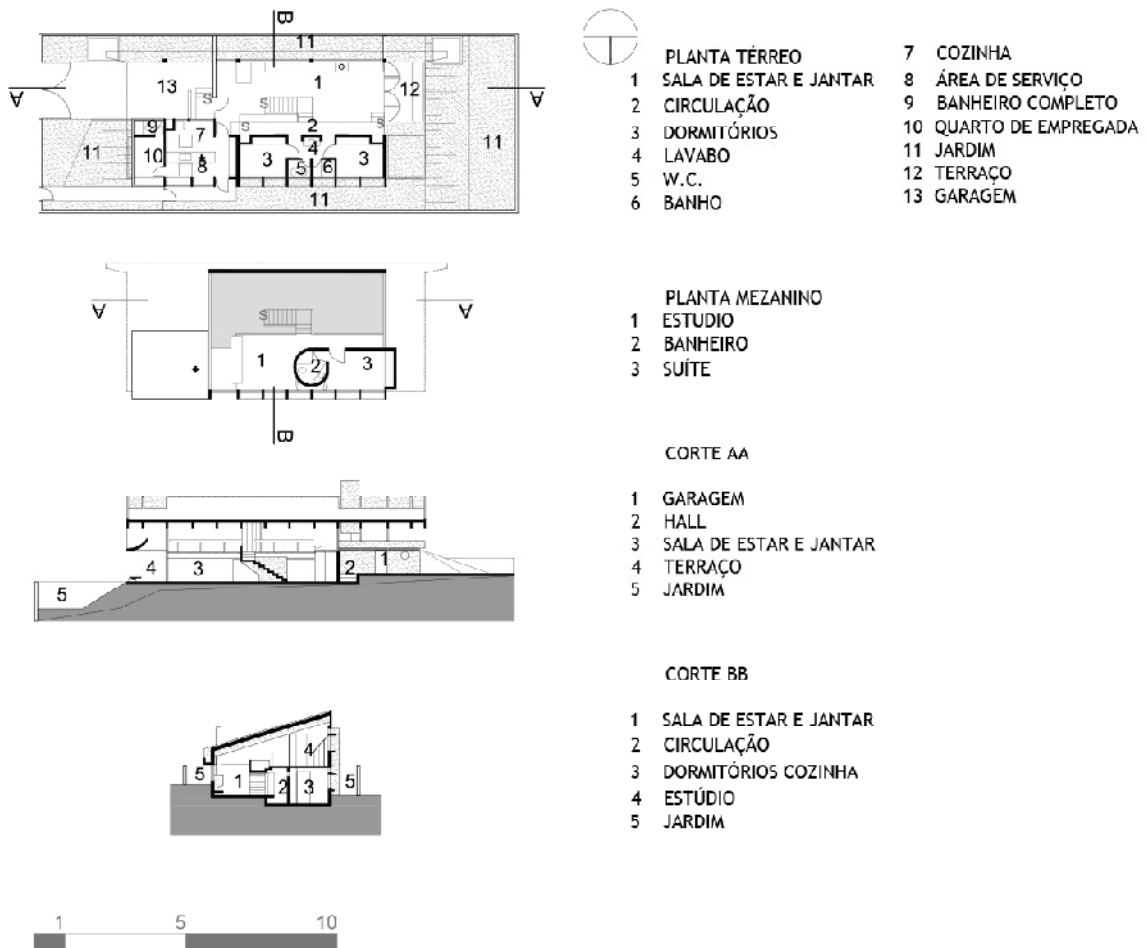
Plantas dos pavimentos inferior, superior e cortes longitudinal e transversal. Fonte: autora.
